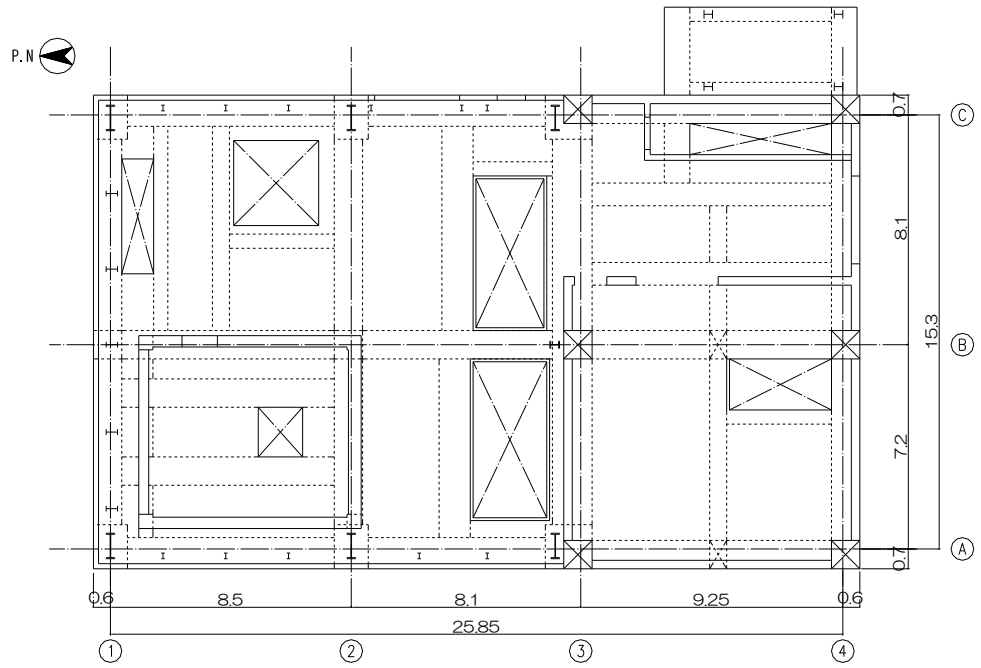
地上1階平面図 (G.L. +0.2) (单位 : m)
